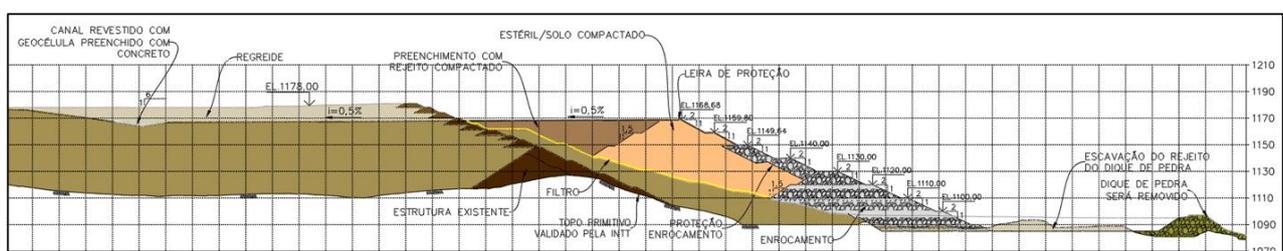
Geometria de descaracterização – Seção transversal - Forquilha I (Fonte: 1850HH-X-40582 – Intertechne)
